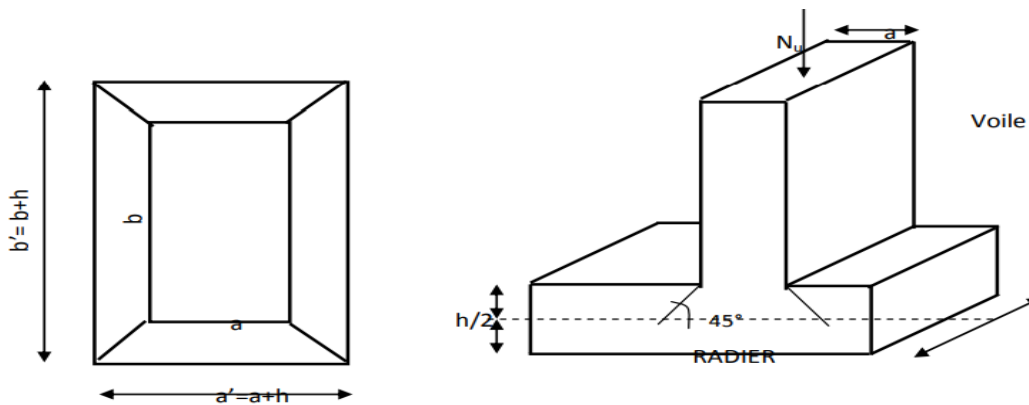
Périmètre utile des voiles et des poteaux.
